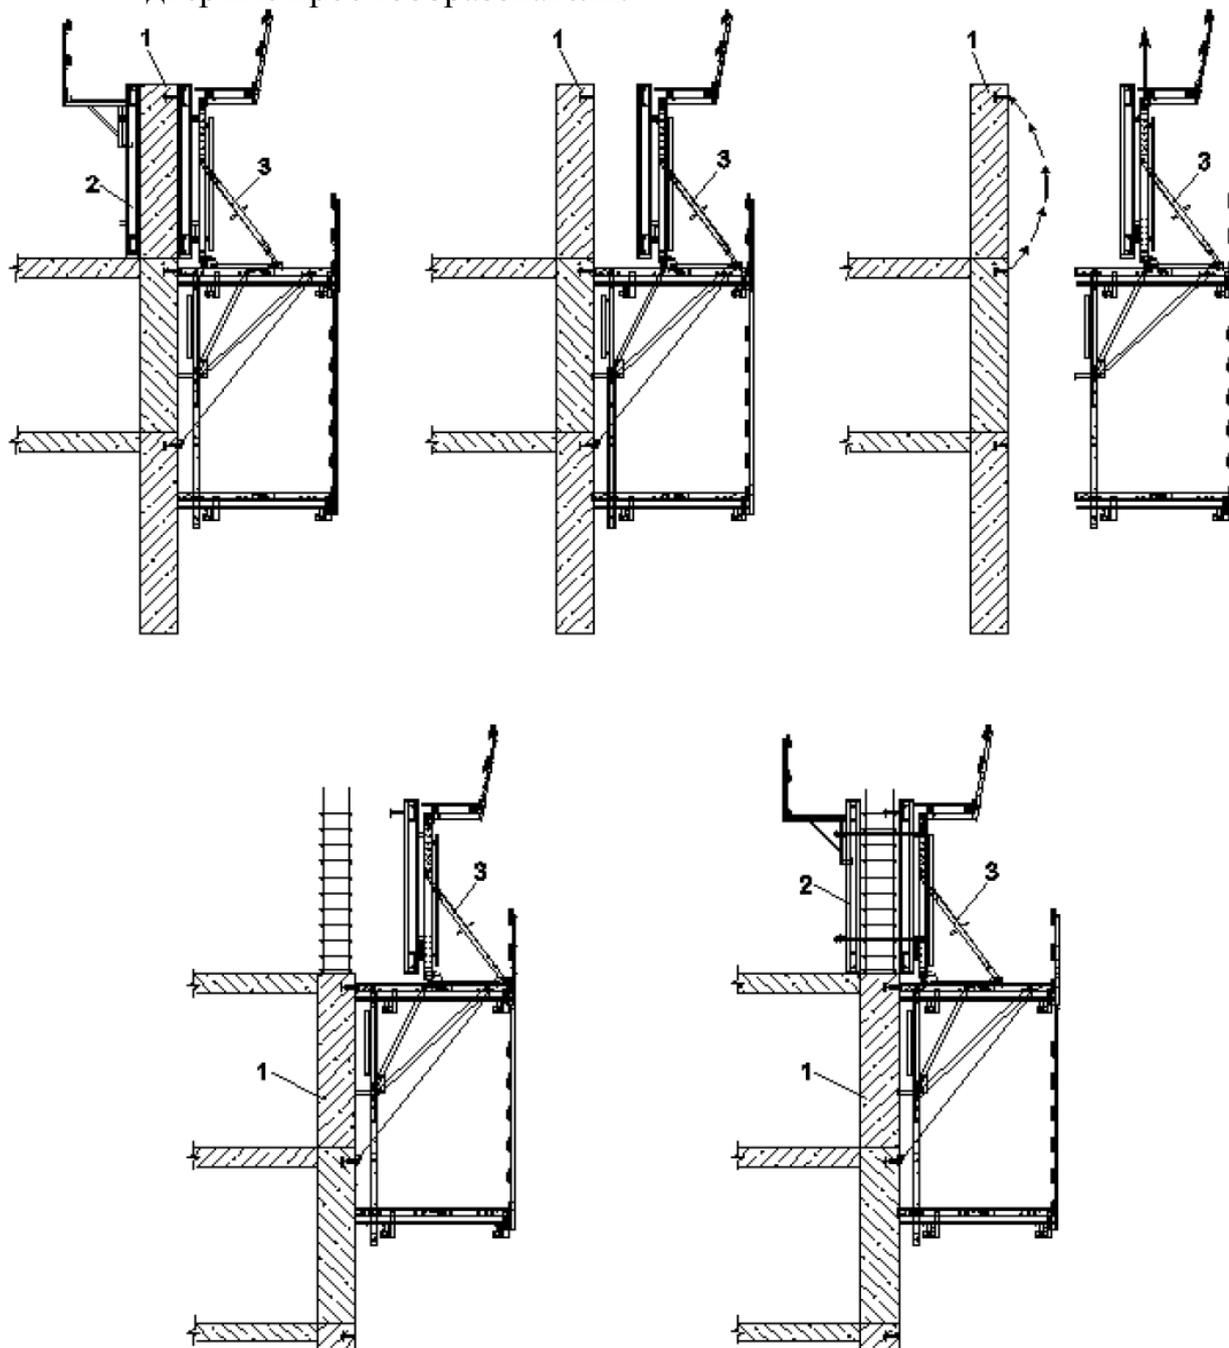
Схема перемещения подъемно-переставной опалубки на следующую захватку 1 – монолитные конструкции; 2 – внутренняя опалубочная панель; 3 – наружная опалубочная панель
